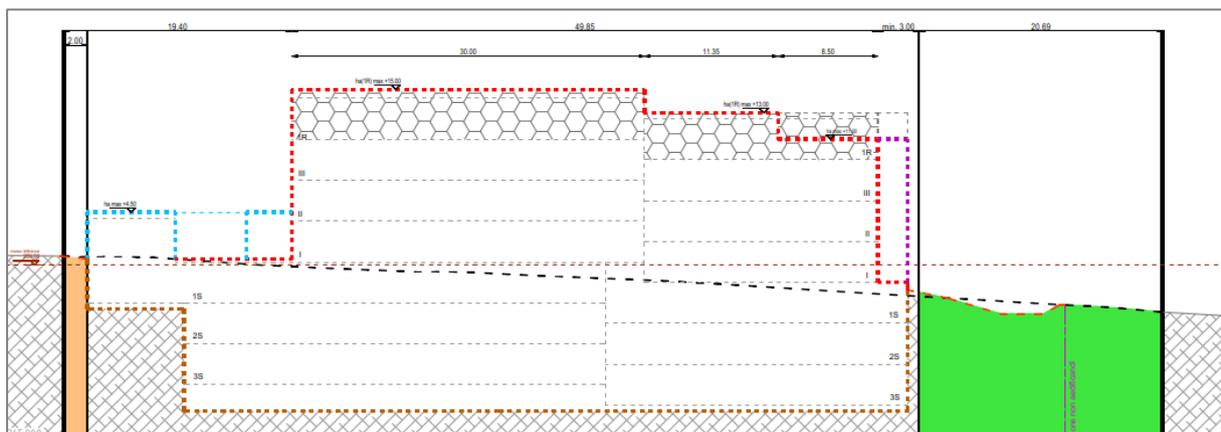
Coupe-Type du bâtiment projeté (Source : BEST)
